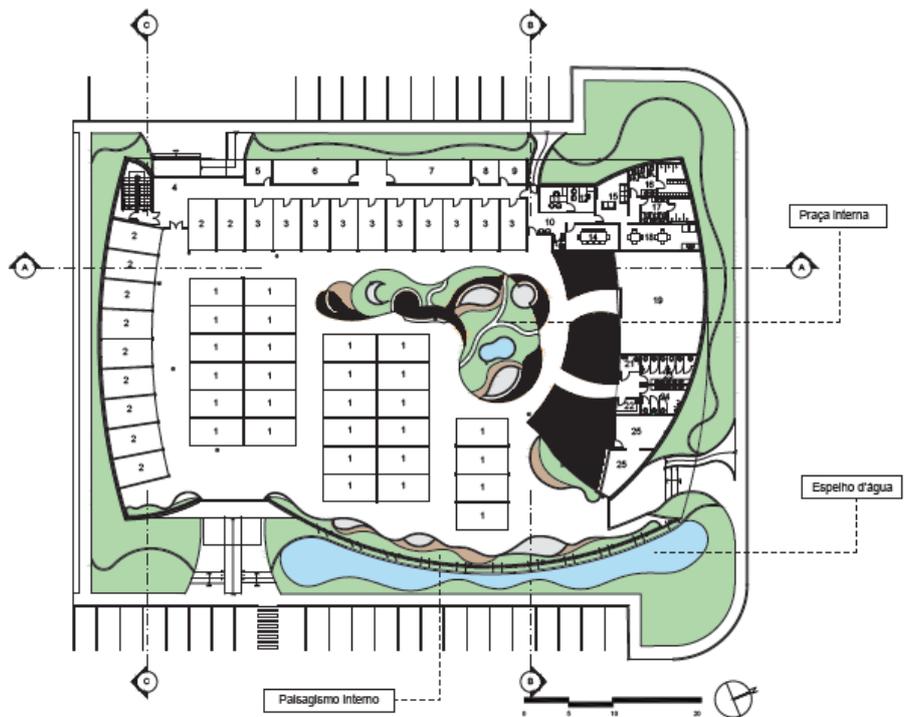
Planta Baixa (Conceito formal do paisagismo). Fonte: Acervo do autor.
